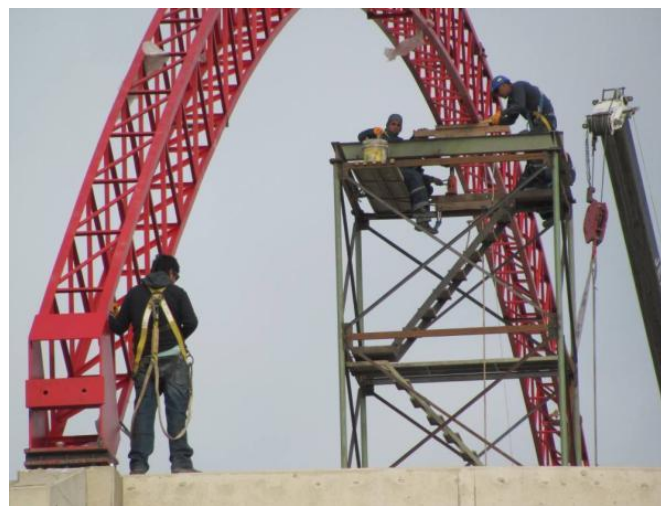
arco principal en pleno montaje e instalación. Fuente:
